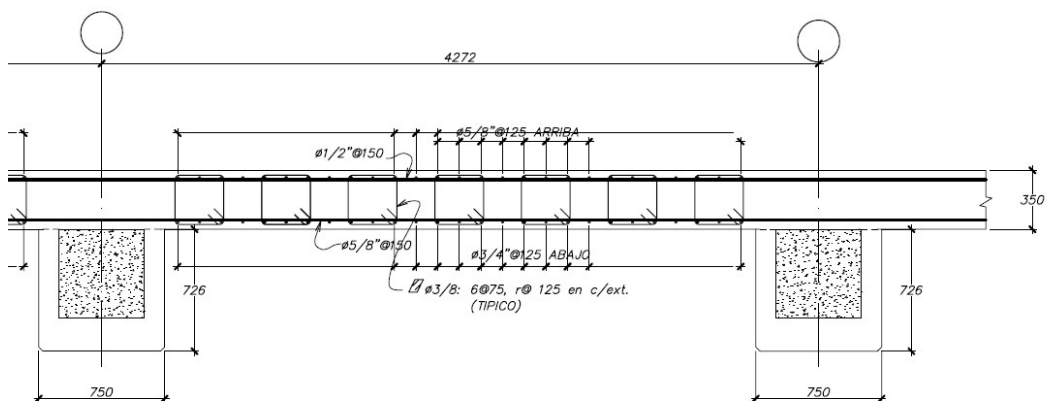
Armadura típica de losa del amarradero 3C – Sección Longitudinal
